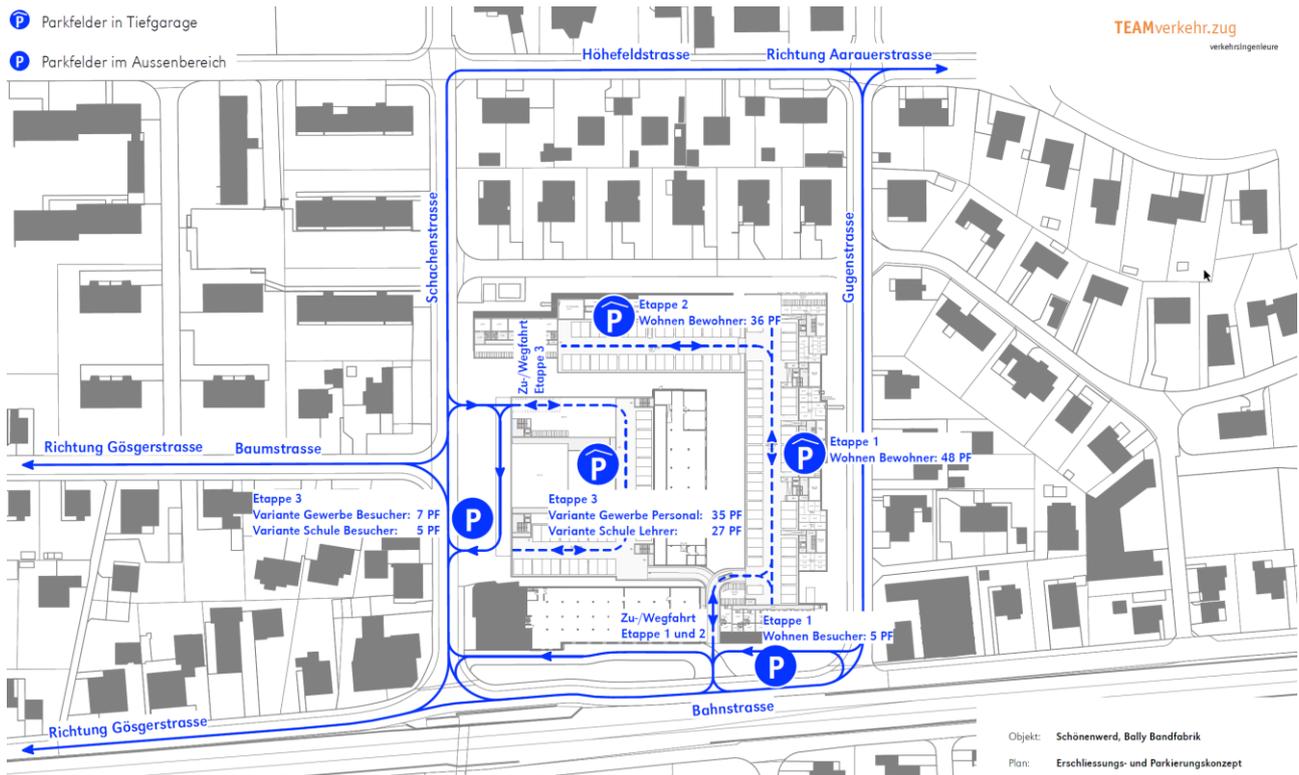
Erschliessungs- und Parkierungskonzept Endausbau (Quelle: TEAMverkehr.zug, 2024)
